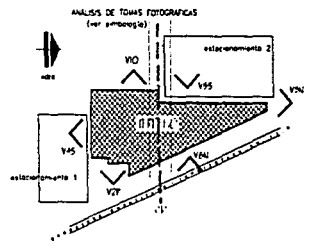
Plano superior: el terreno de la propuesta núm. 5
